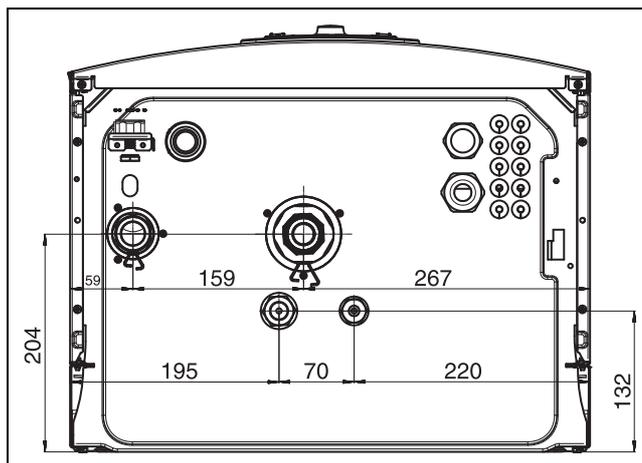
Abmessungen und Anschlüsse (Maße in mm)
